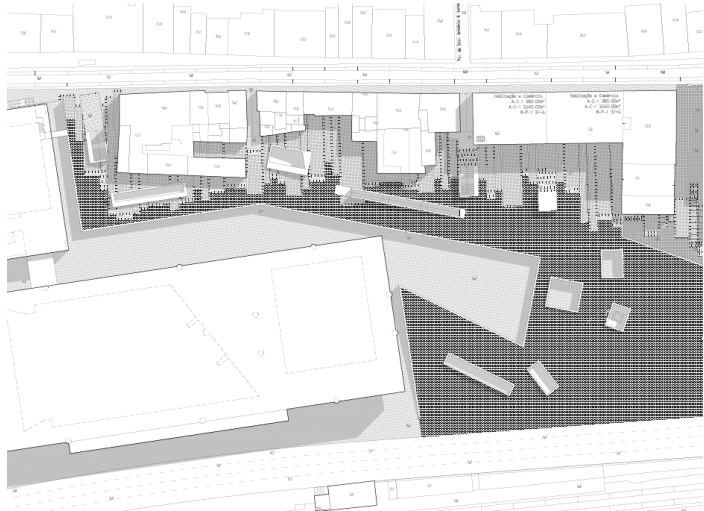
Excerto da Planta de Apresentação, Zona Poente
